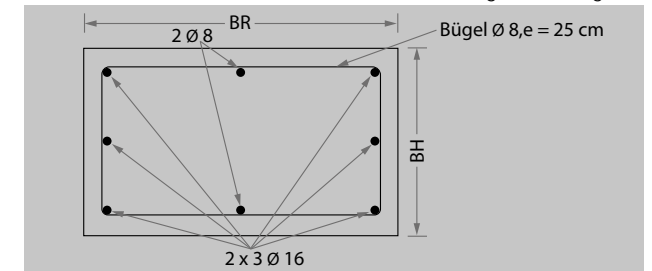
, Betonringanker (Bsp: Tabelle 2 – 4 m x 10 m)
